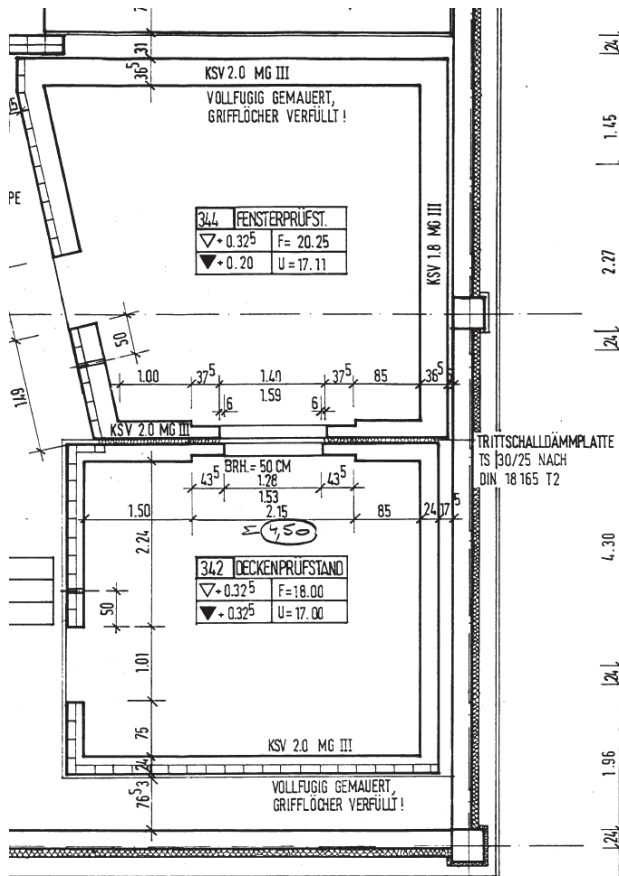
Grundriss Fensterprüfstand [3].
